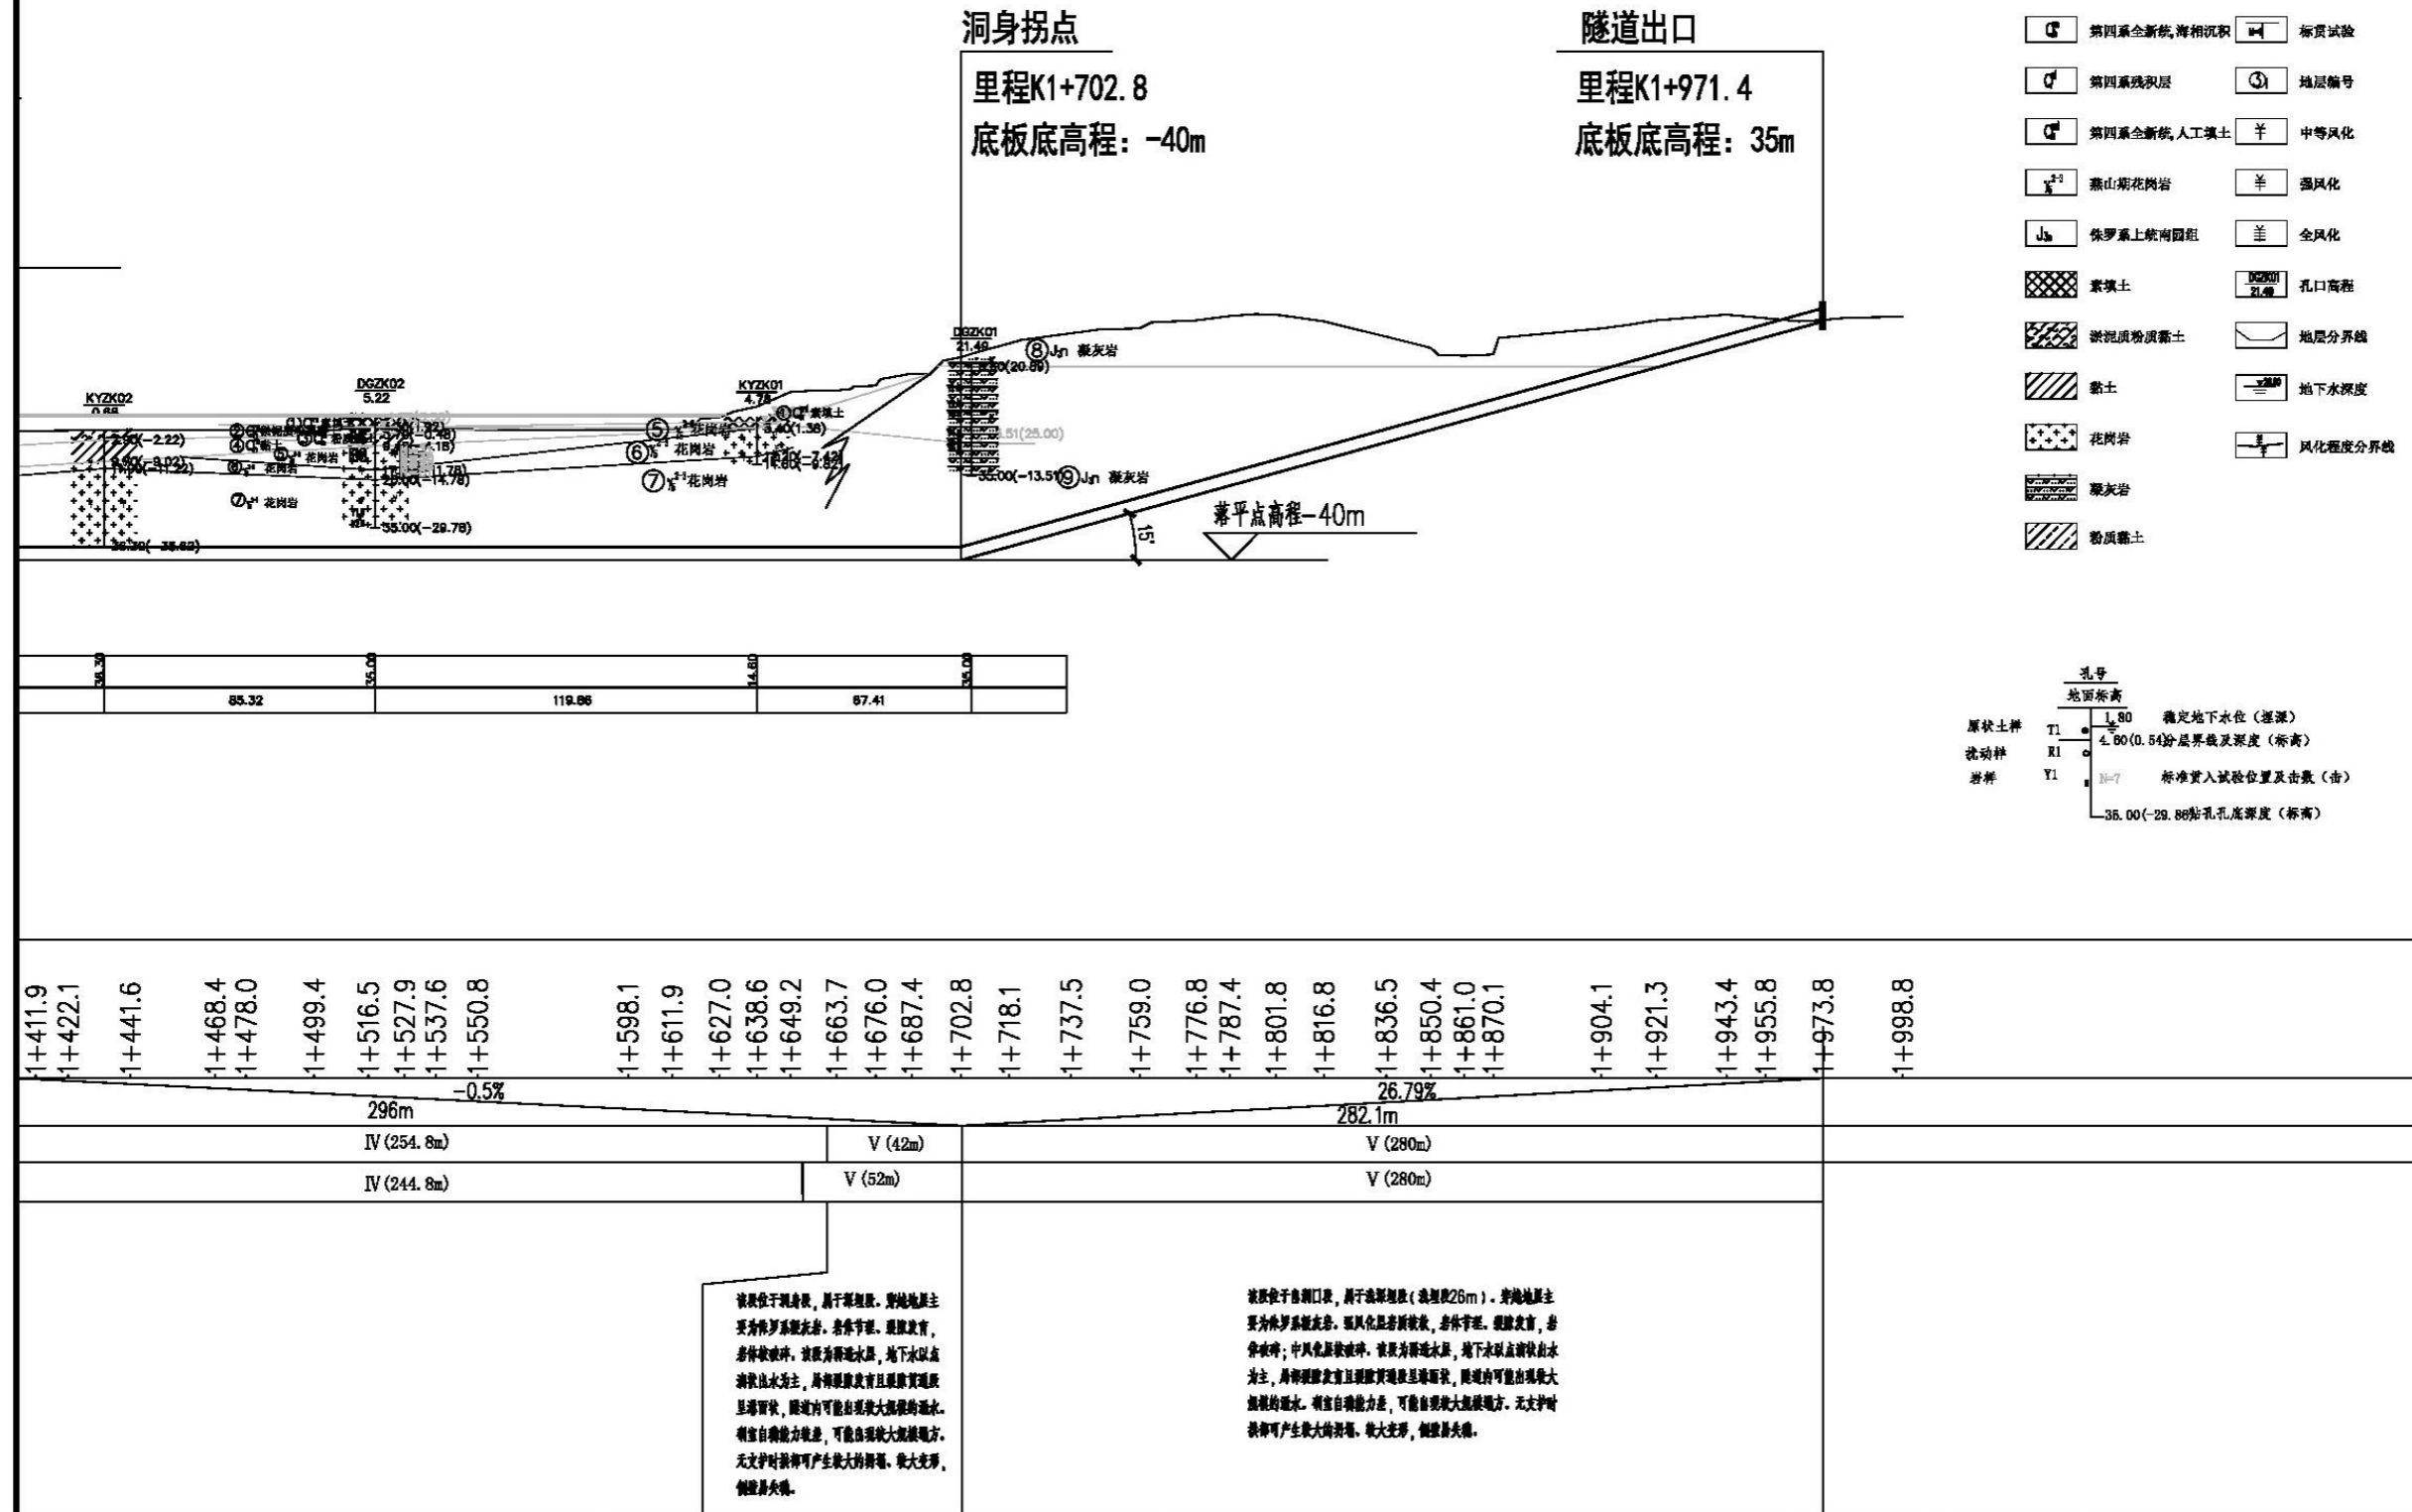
东港隧道穿越纵断面示意图 (3)
